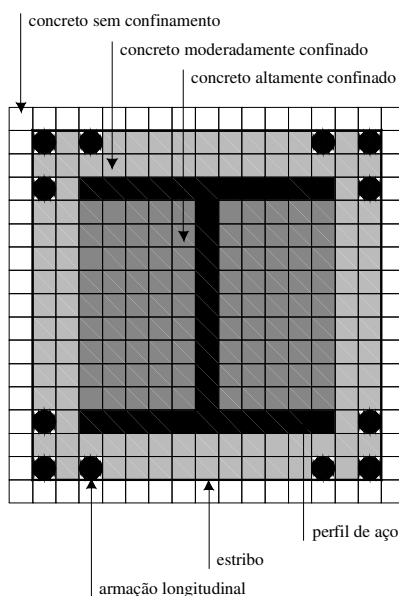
Discretização das fibras da seção transversal mista de um pilar.
